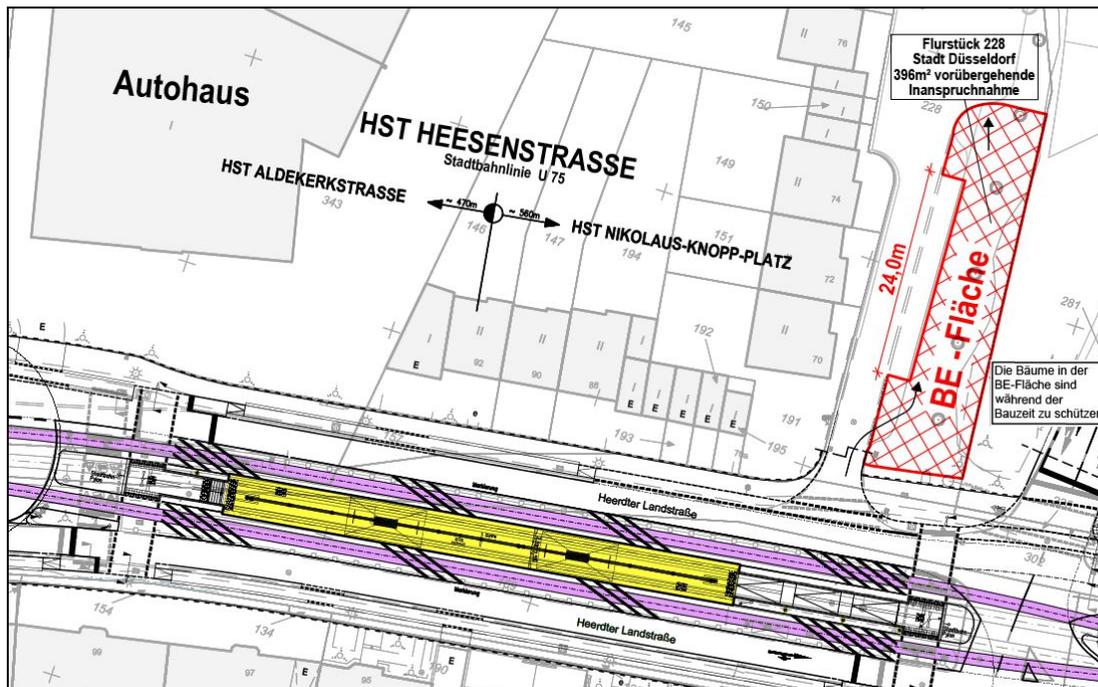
Baustelleneinrichtungsfäche Hst. Heesenstraße (WENDT Juli 2018)
